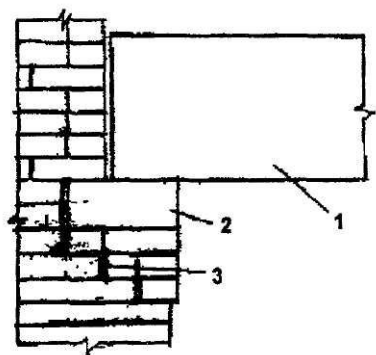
Схема разрушения каменной кладки под опорной подушкой. 1 — балка; 2 — опорная подушка; 3 — наклонная трещина.
